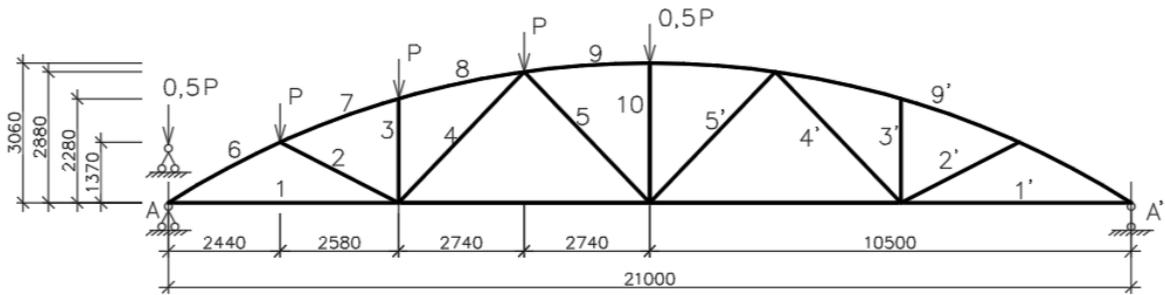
Расчетная схема многоугольной брусчатой фермы
